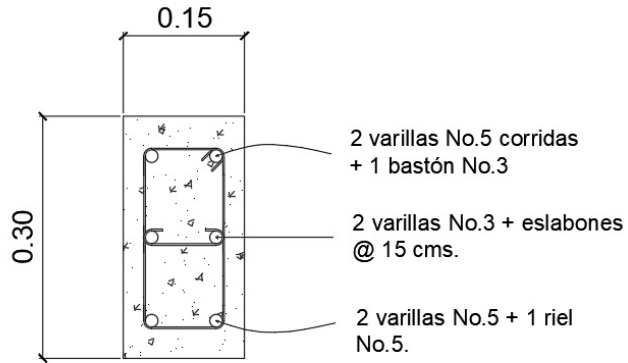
Armado de viga no pretensada en aula (tensión)
